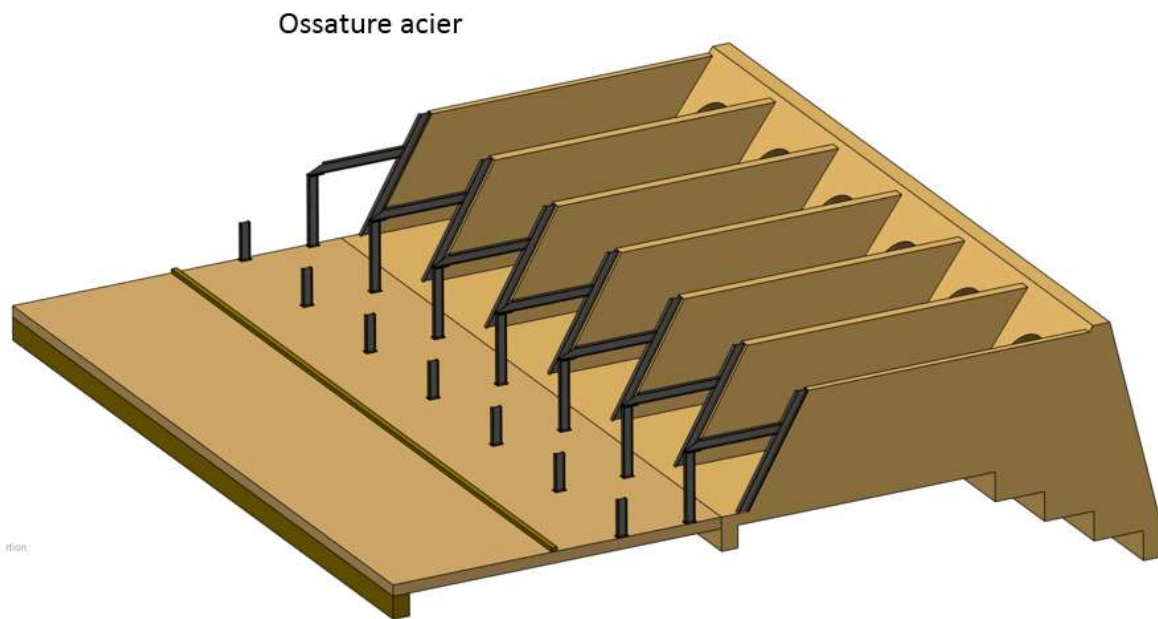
Vue d'ensemble structure mécano soudée plan de grille
